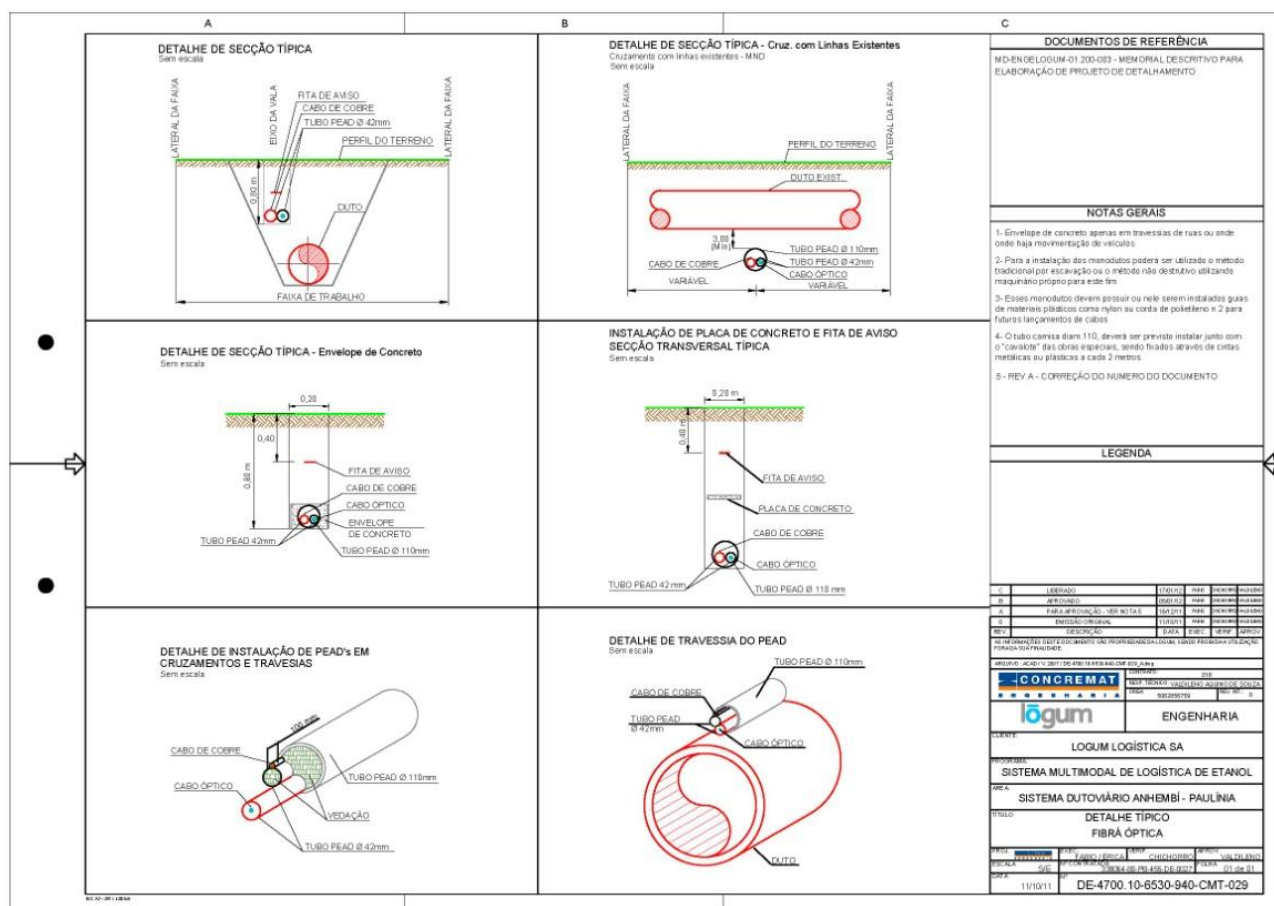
Detalhe típico esquemático etapas de construção e montagem tubulação
